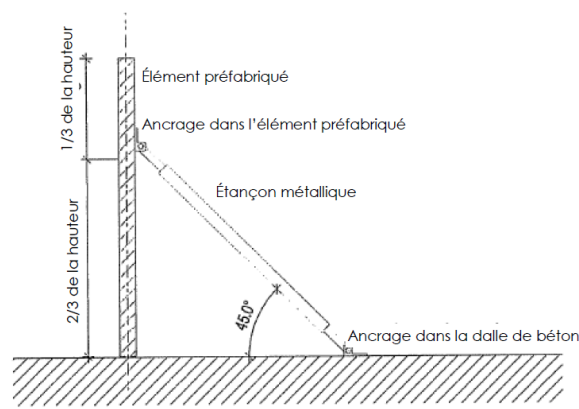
Pose des étais tirant poussant et des renforcements lors d'une pose sur support béton armé
